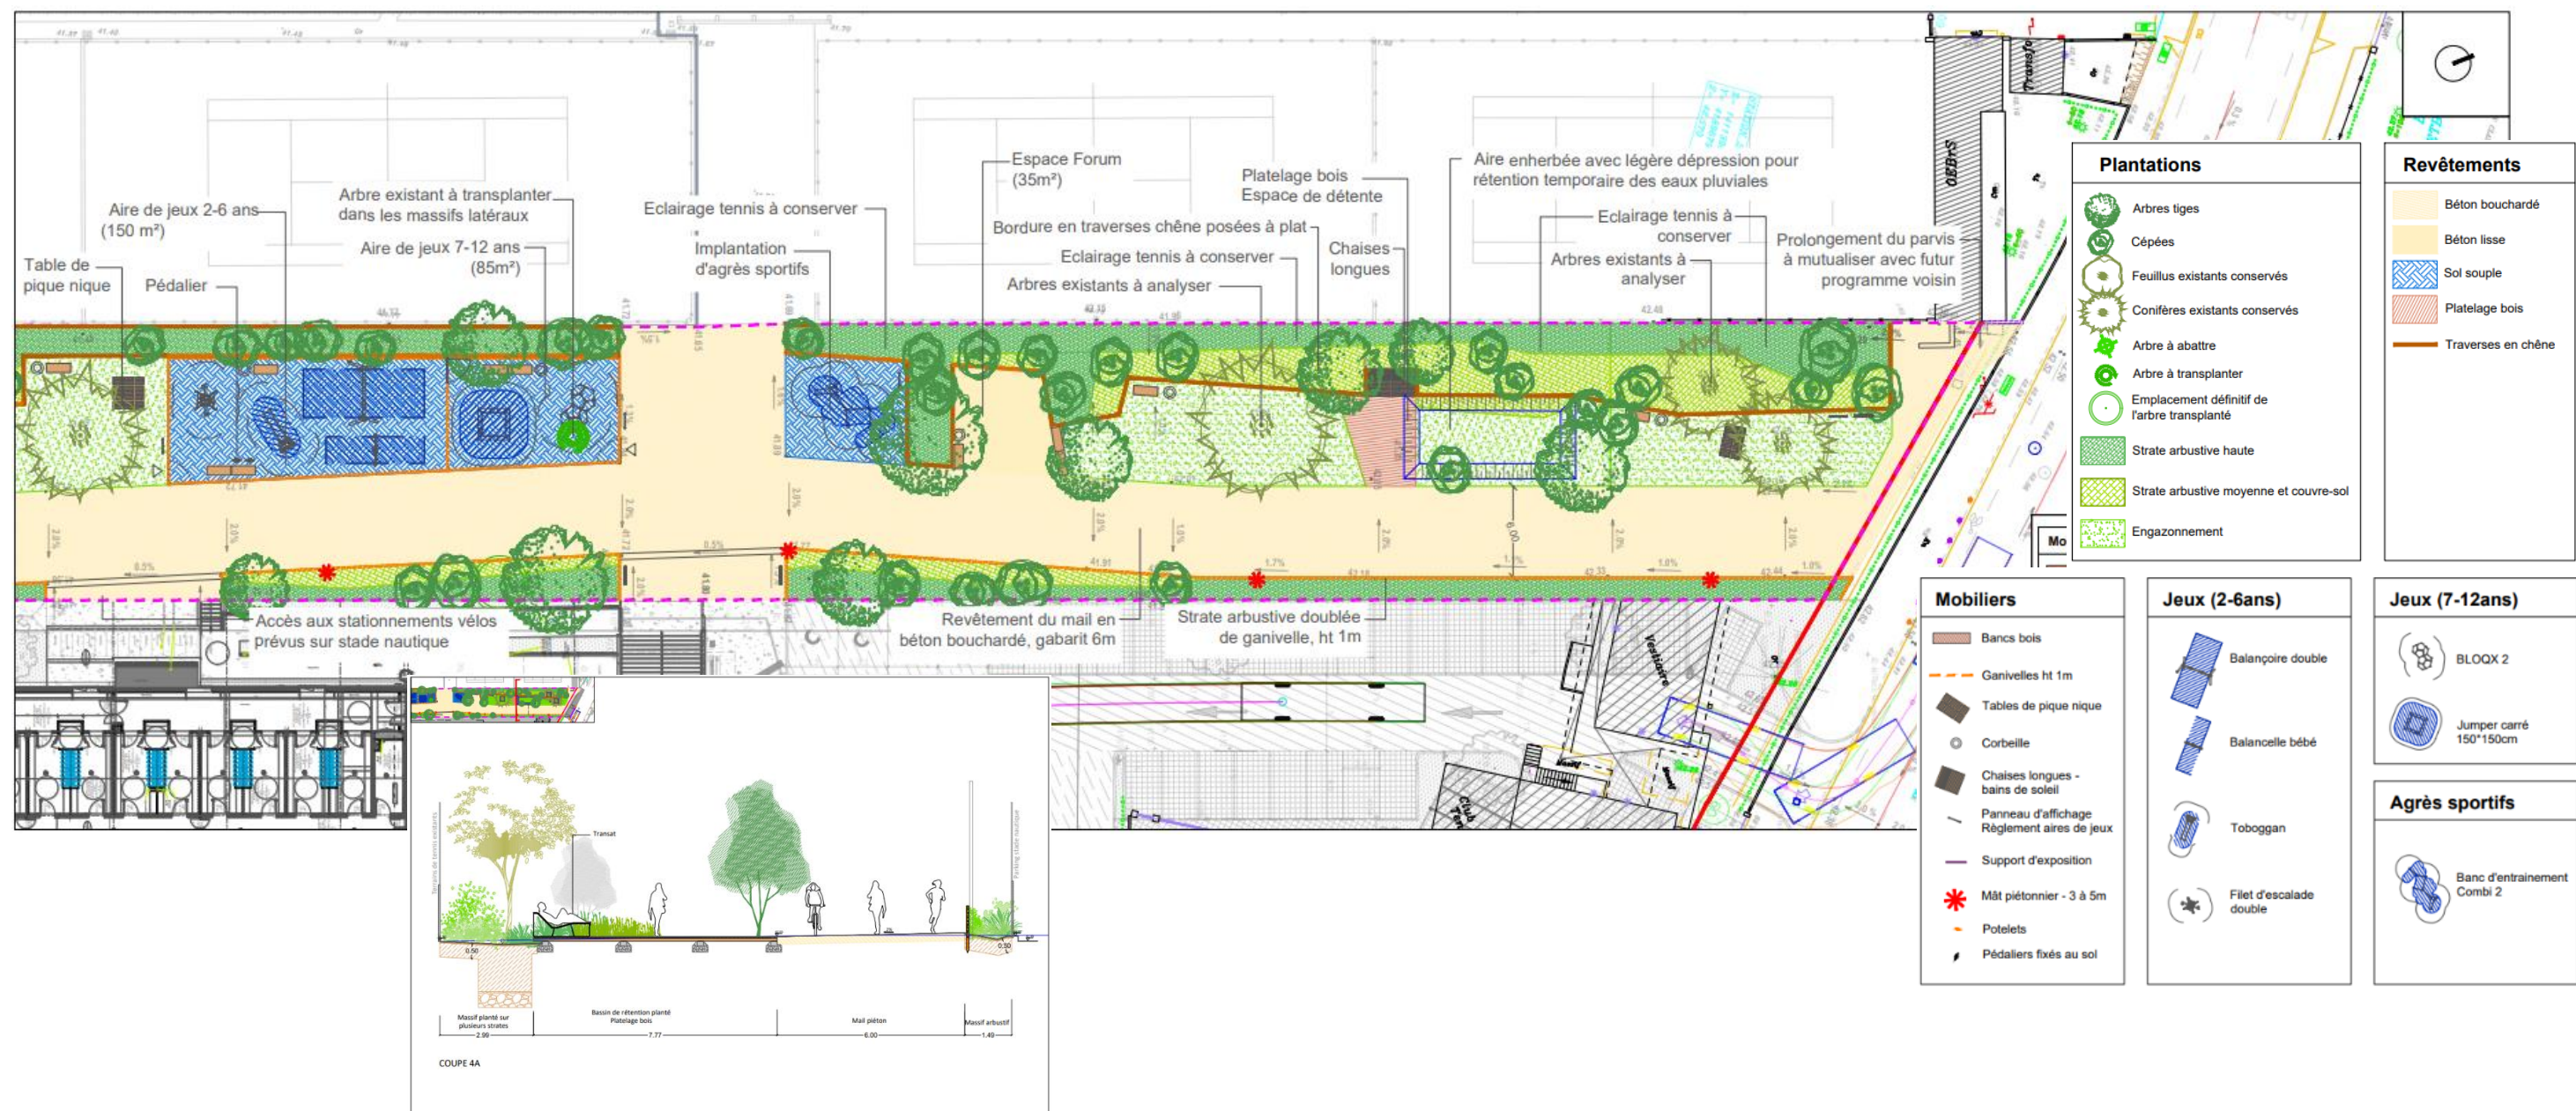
Extrait du plan masse des travaux de construction du mail piétons/cycles SAMPERI – planche 1/2 (Source : Ville de Mérignac)
